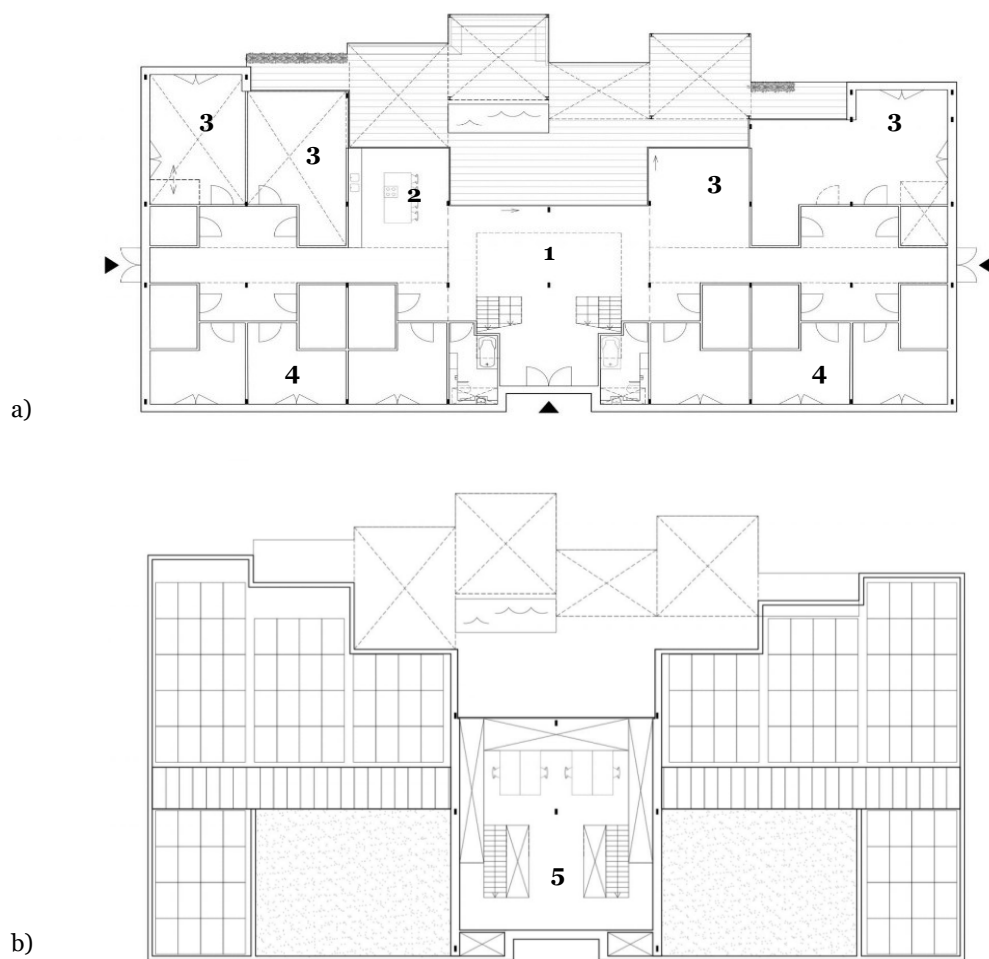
Planta de piso (Rohmer, s.d.): a) planta de piso 0; b) planta de piso 1
